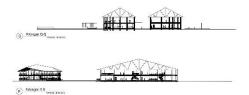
Tampak Fasilitas Batik & Galeri Workshop
